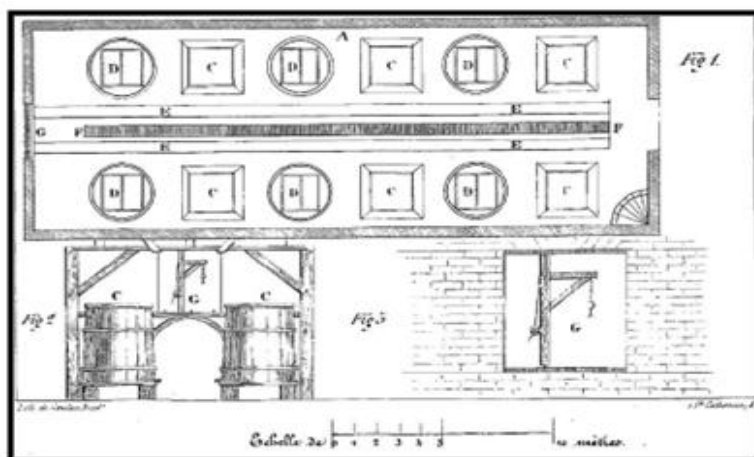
1: Plan et coupe d'un cuvier medocain.
